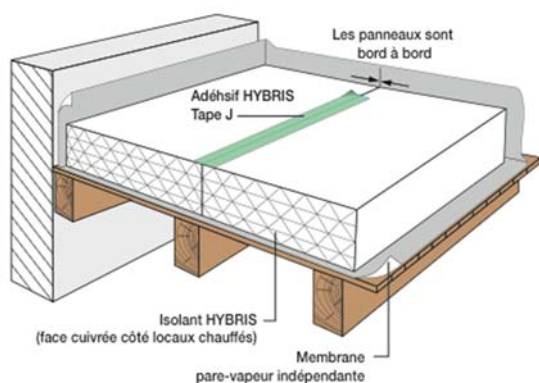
isolation en combles sur plancher bois : panneaux posés bord à bord (avec pare-vapeur déporté)
